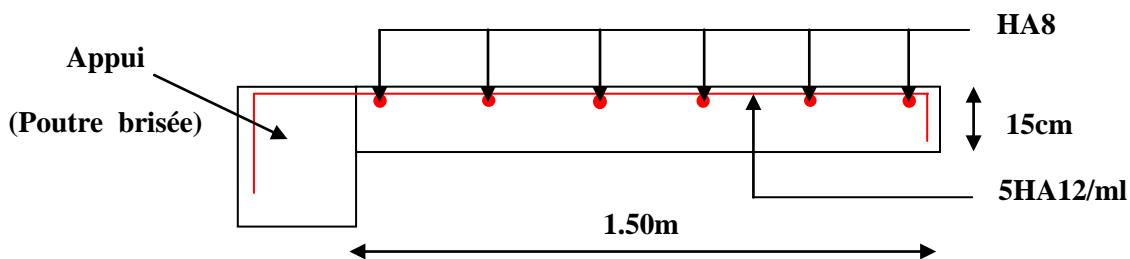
Schéma de ferrailage de la volée 2 de l'escalier.
